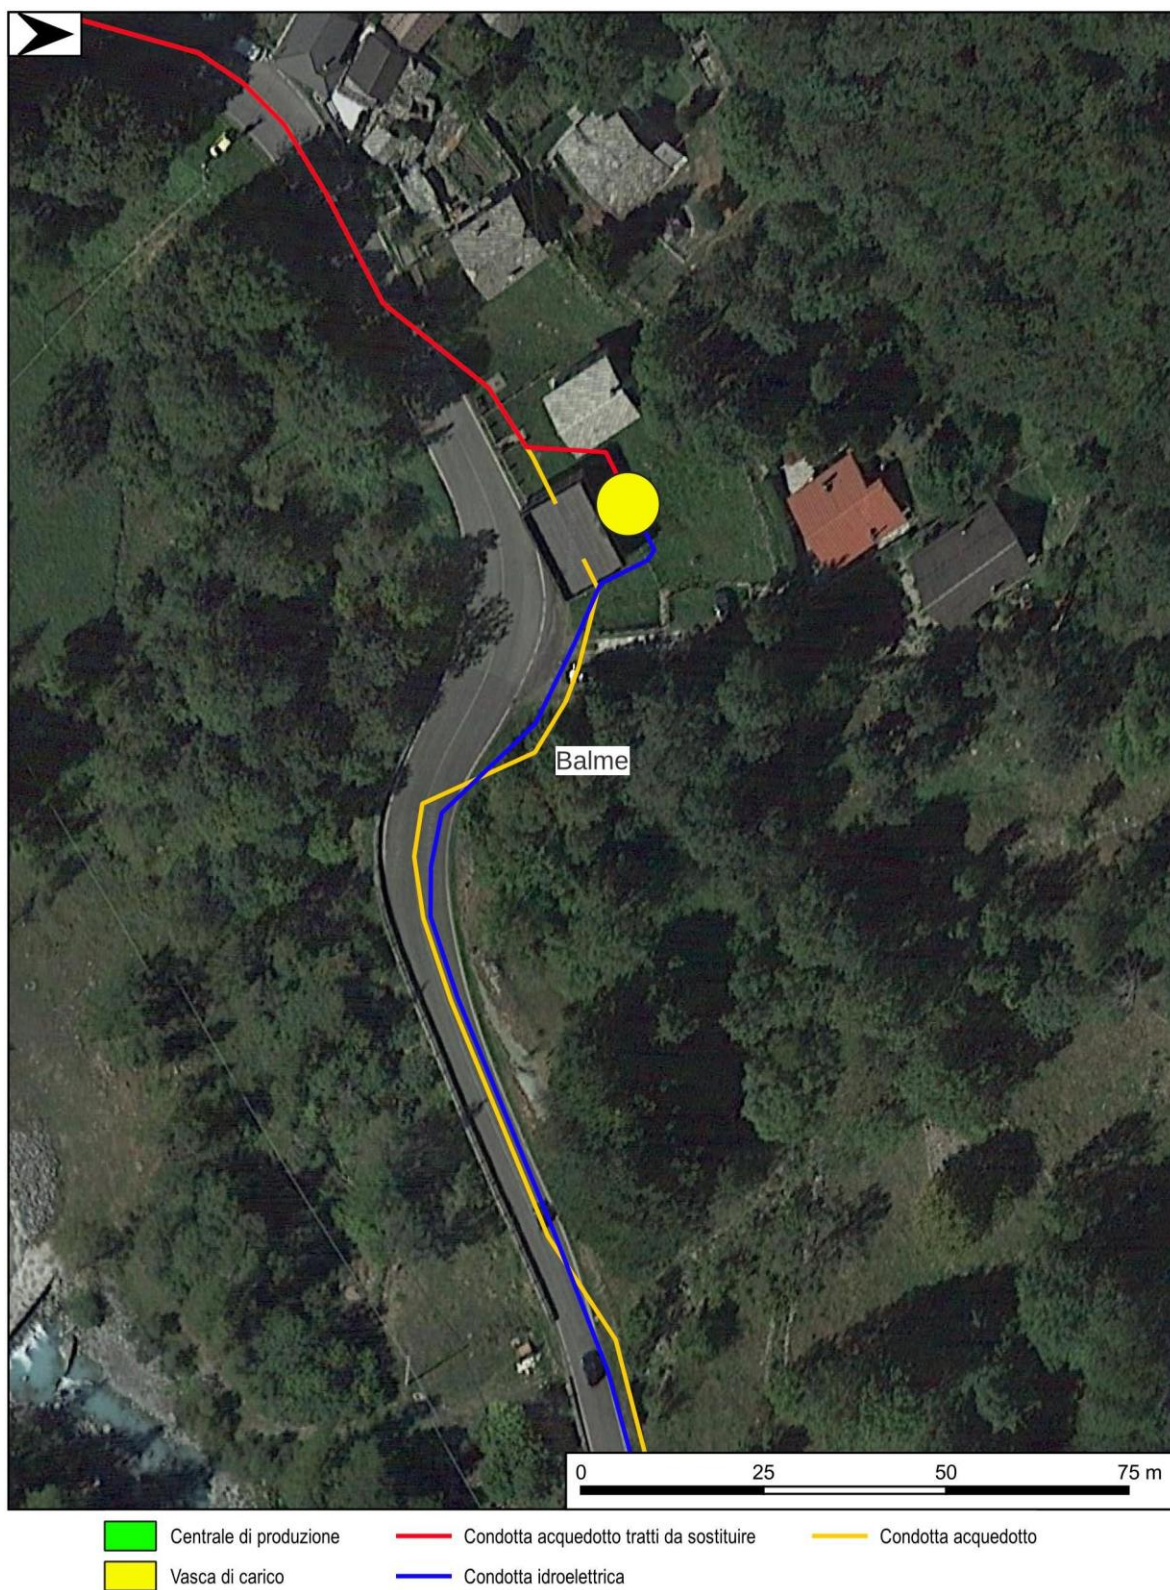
Planimetria delle attività in progetto – Dettaglio Area Vasca di Carico
